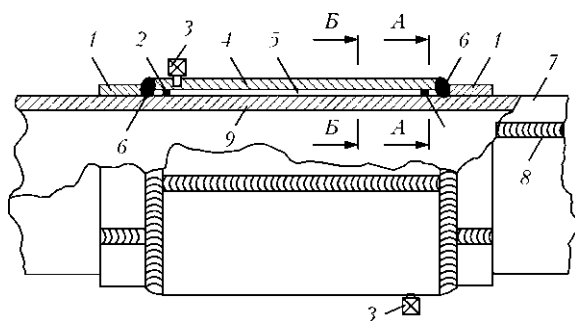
Схема способа ремонта с помощью герметичной муфты с наполнителем [3]: 1 — технологические кольца; 2 — тонкостенное дополнительное кольцо; 3 — штуцер; 4 — муфта; 5 — наполнитель; 6 — кольцевые сварные швы; 7 — трубопровод; 8 — продольный шов; 9 — дефектный участок
